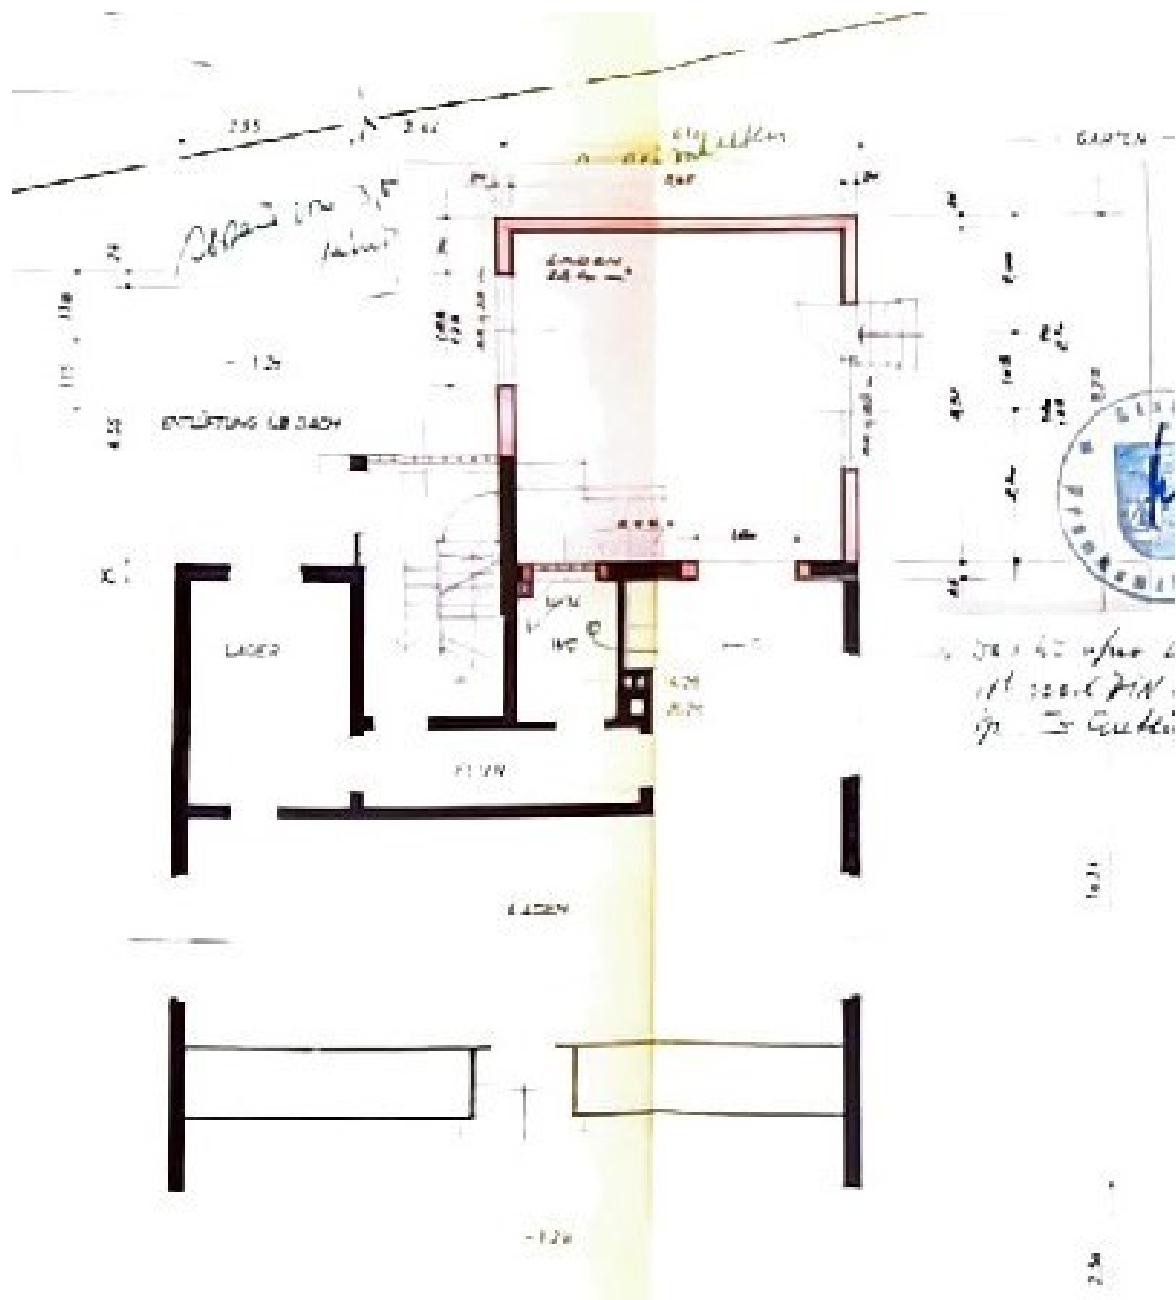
Ausschnitt aus dem Grundrissplan Erdgeschoss (aus Bauakte 1968)
